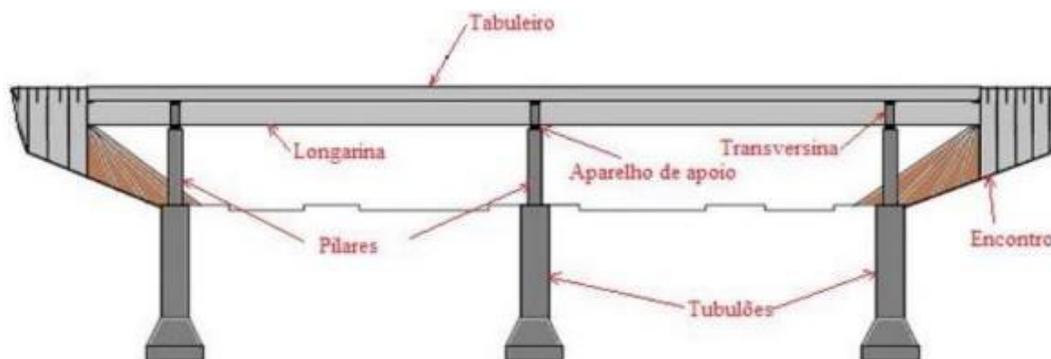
Exemplo de divisão estrutural de uma ponte (Jovem, T.P. 2017- Dissertação UFRN)
